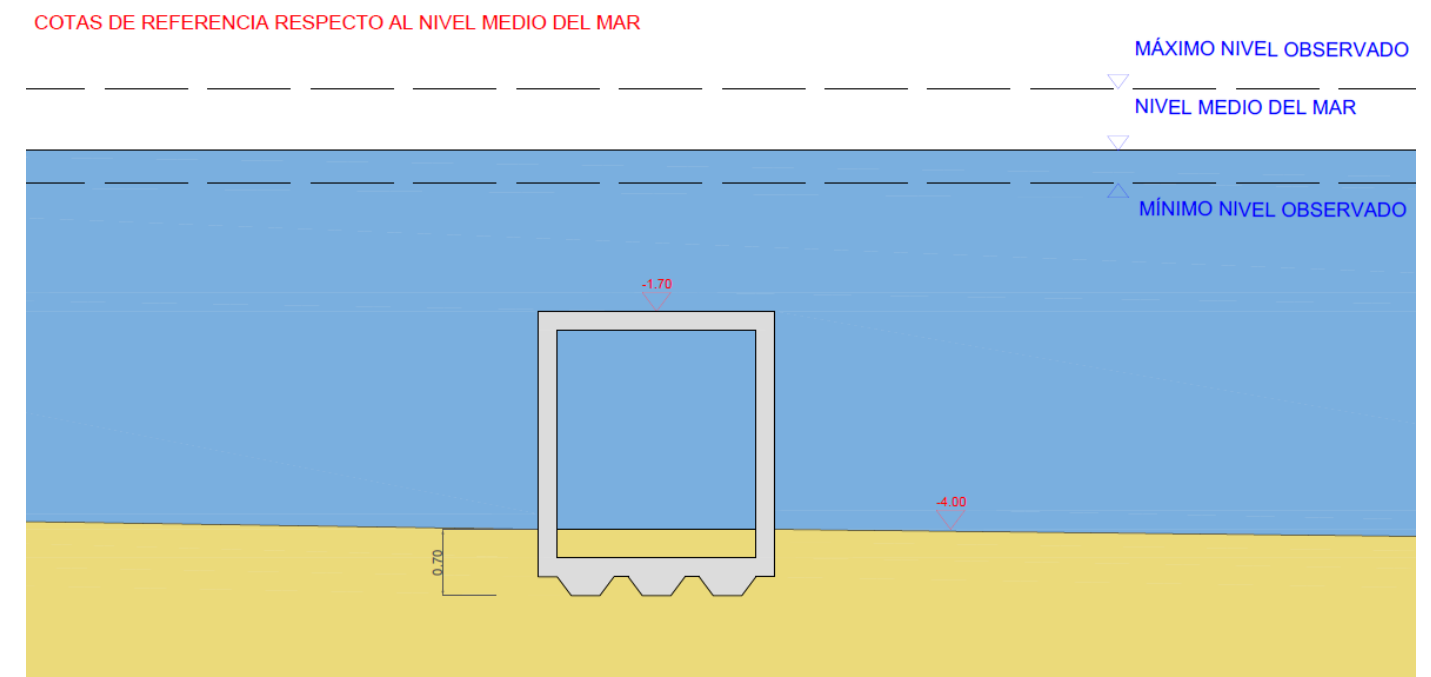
Sección transversal de la estructura asentada en el fondo. (Fuente: plano 7.1, 2023)
